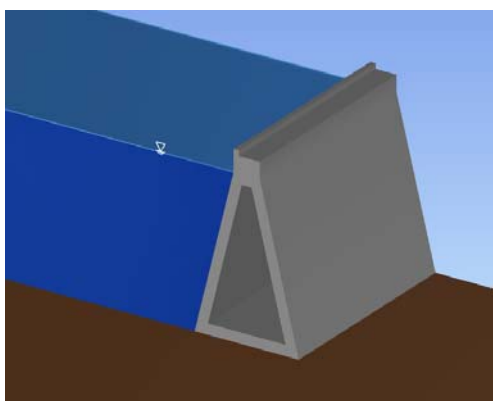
重力式コンクリートダムの断面例 写真－3.2.1 重力式コンクリートダム（湯西川ダム）
